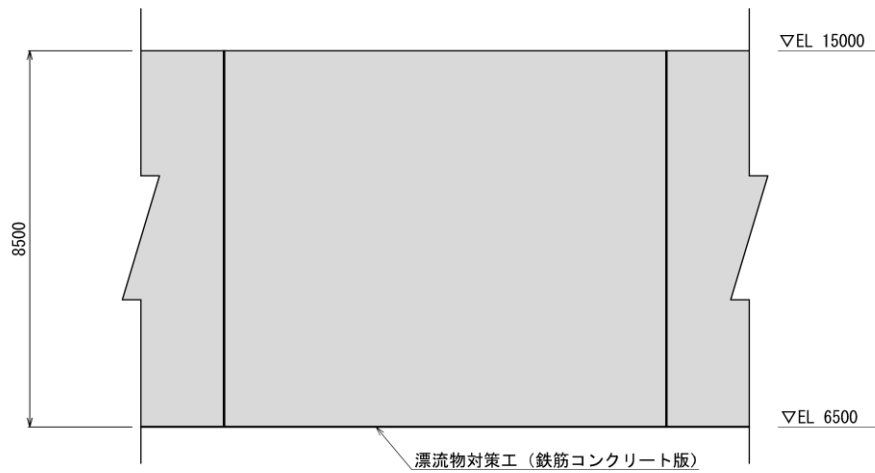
(1) 防波壁 (波返重力擁壁) 重力擁壁における漂流物対策工 (鉄筋コンクリート版) の構造概要図 (正面図)
